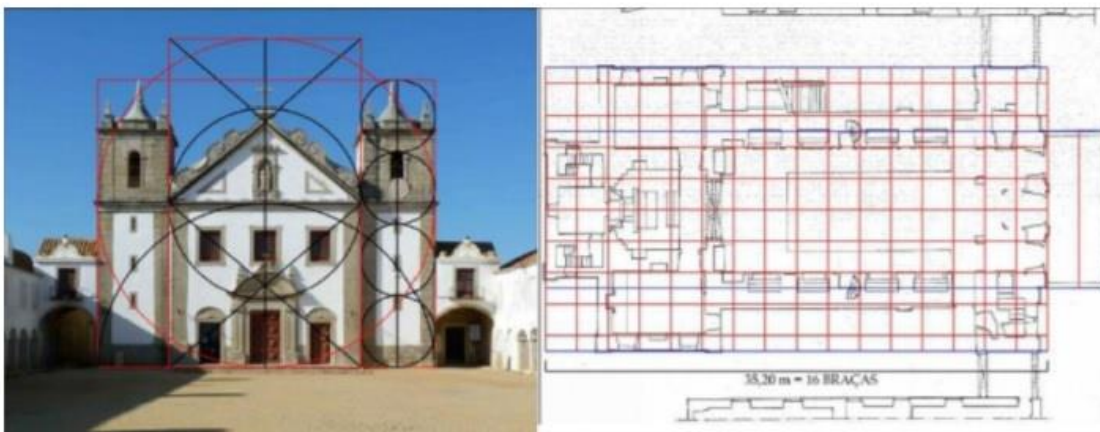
Geometria na fachada principal e planta, da igreja
